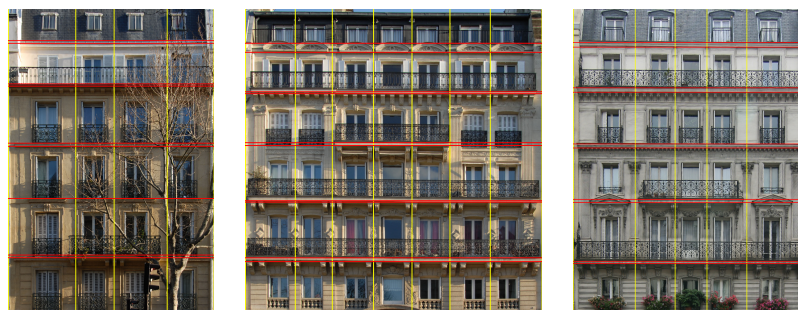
Division de la façade en étages + dalle et en travées.
